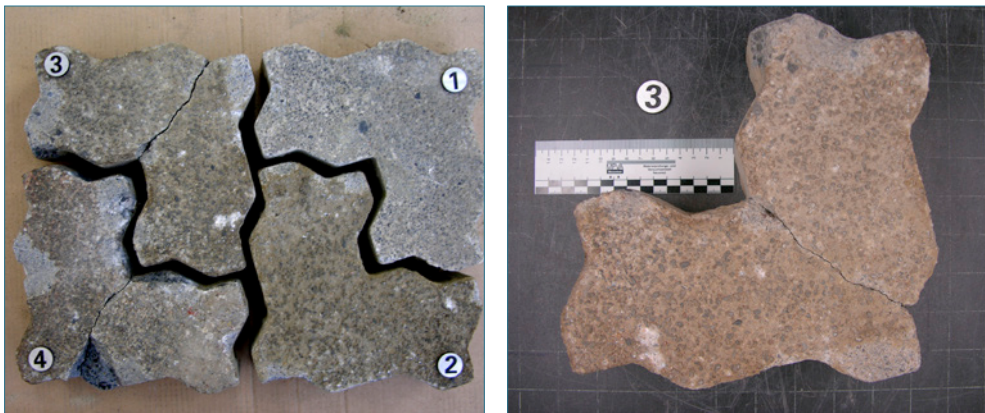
Materialabtrag an den zu bewertenden Betonpflastersteinen
